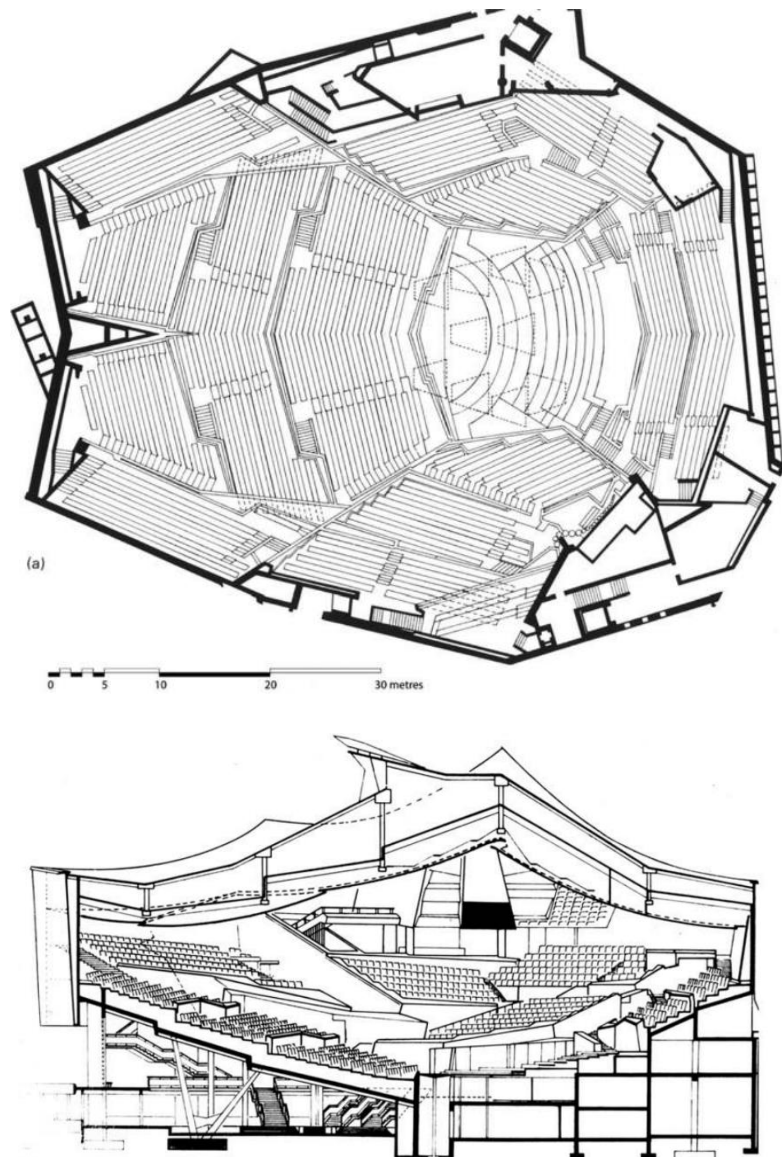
Filarmónica de Berlim, Berlim. Planta e Corte Longitudinal (Barron, 2009)
